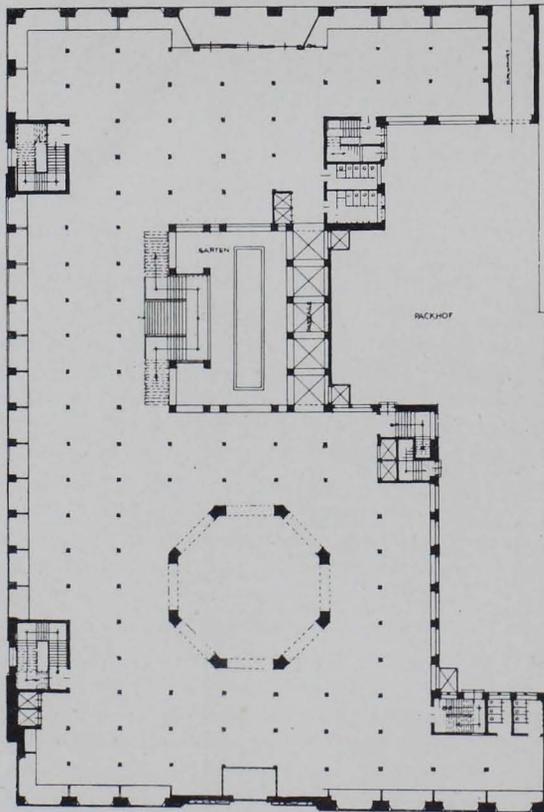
Entwurf eines Warenhauses. 1906. Grundriß des Erdgeschosses
